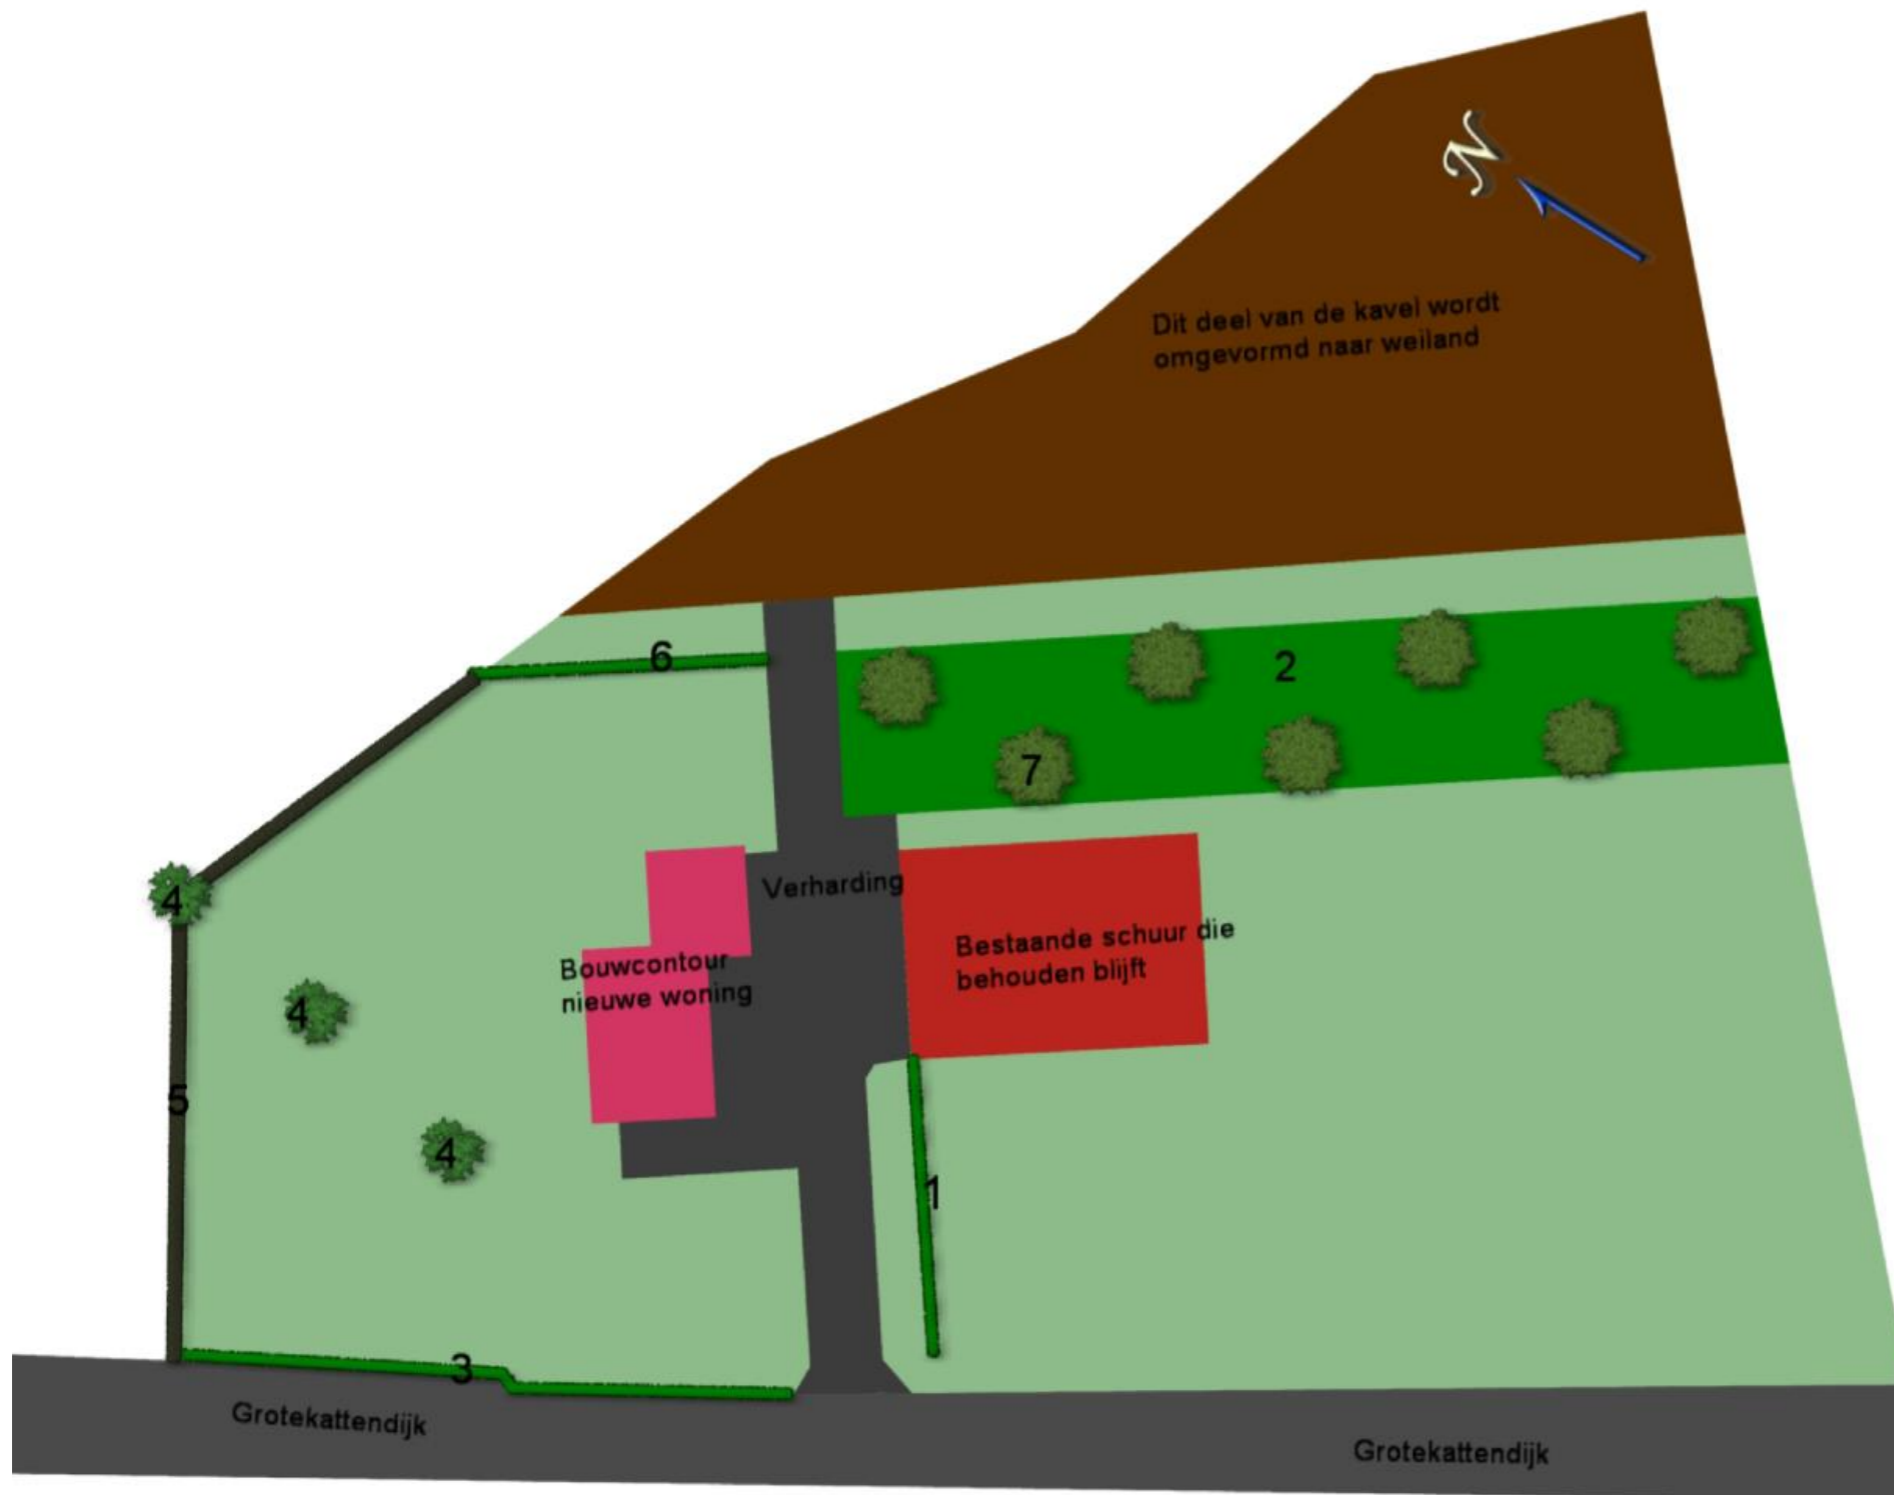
bovenaanzicht planlocatie Grote Kattendijk 6
